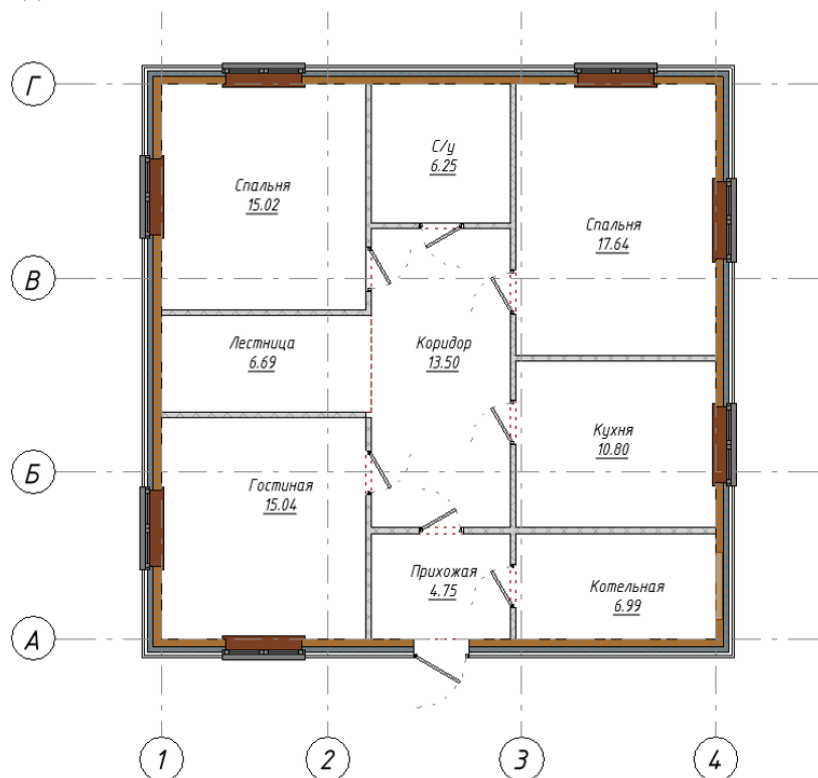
План 1-го этажа малоэтажного жилого здания
